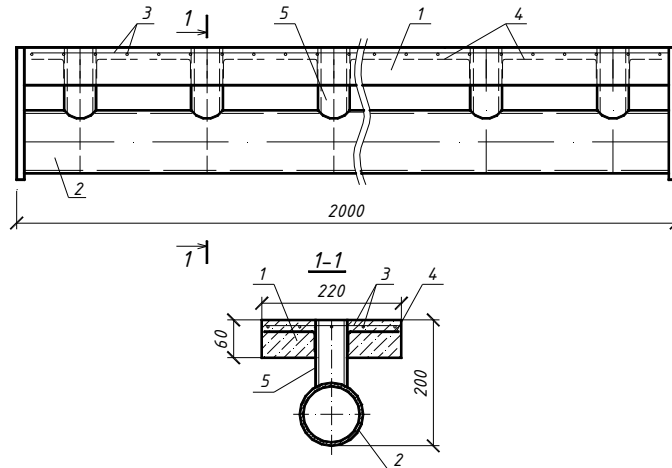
Сталезалізобетонна балка з армуванням трубою
